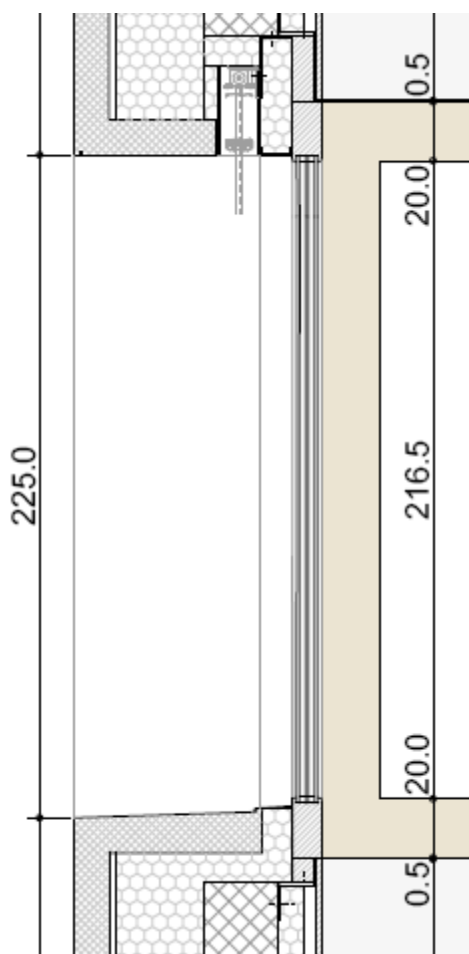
Detalhe do isolamento exterior na ligação da fachada com o vão envidraçado.
